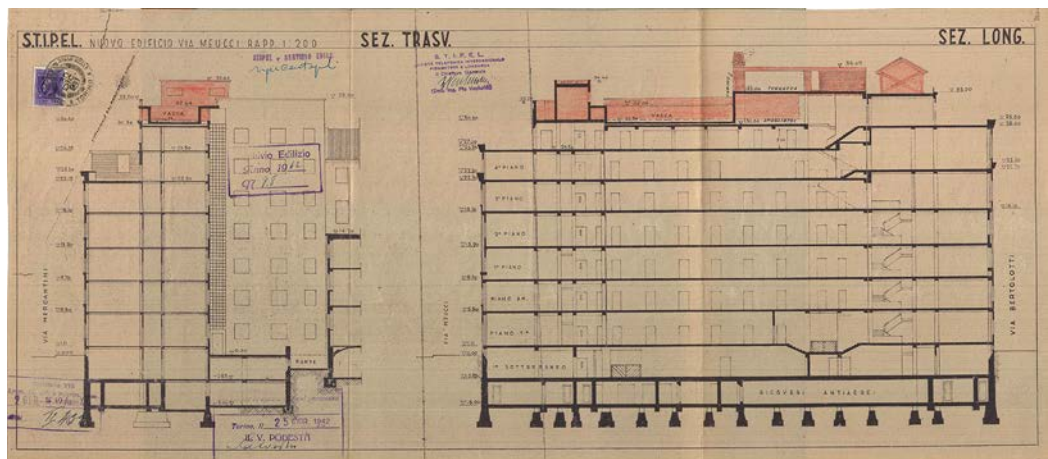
Sezioni trasversali e longitudinali dell'edificio, a firma dell'architetto Castagnoli, 1942 (Archivio EdificaTO).
